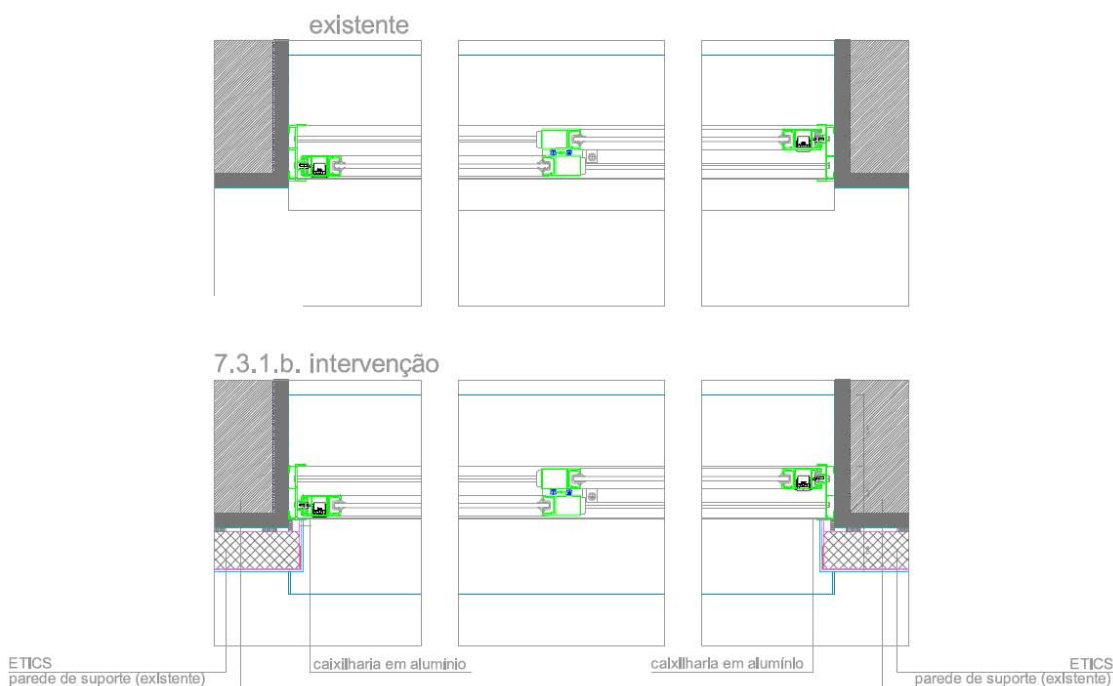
Novo vão de habitação recuada da cobertura. Pormenor construtivo horizontal (escala 1/10).
